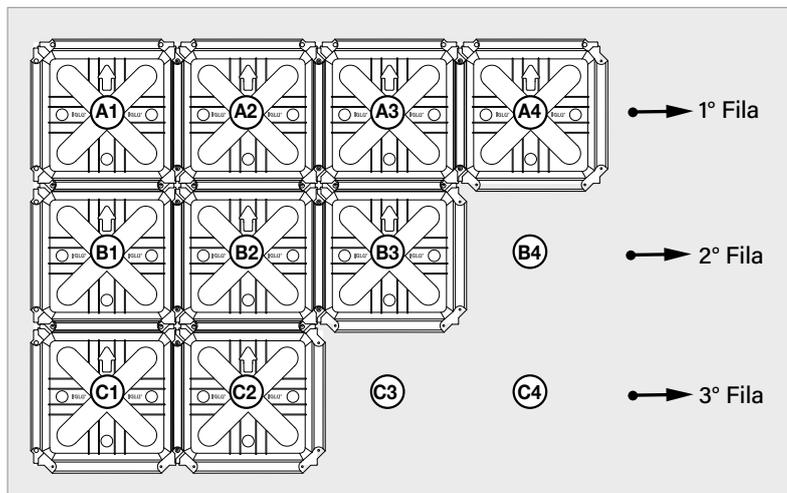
Sequenza di posa a secco degli elementi per righe.
